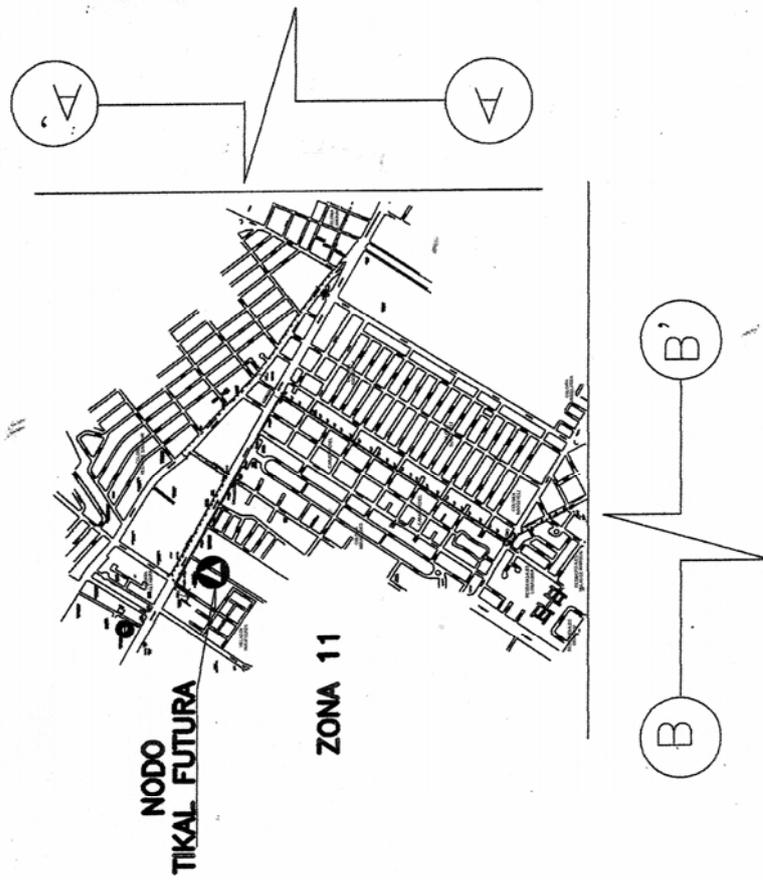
Plano enlace Aristos El Cortijo zona 11 y 12
